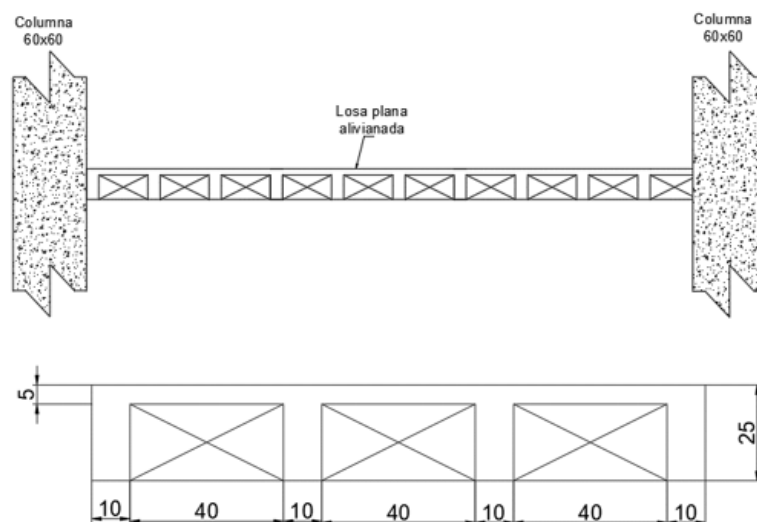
Detalle de Losa plana de la planta baja edificio EERCs.
